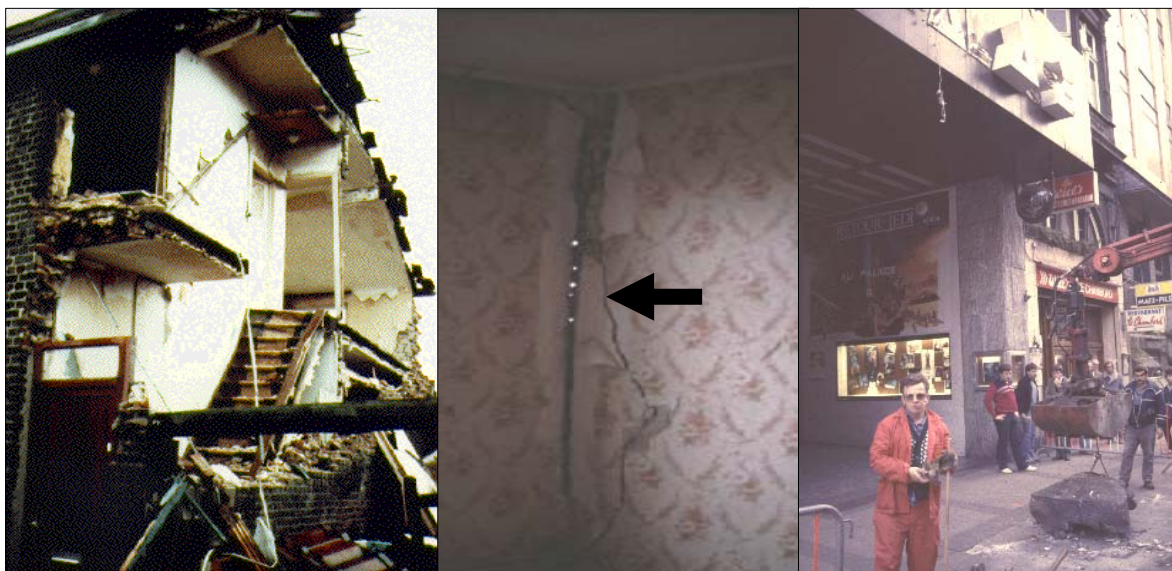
Liège, 1983. Effet de la faiblesse des diaphragmes (fissuration à l'angle des murs) ou de la faiblesse de leur connections aux murs (effondrement de façade). Chute d'un parement en pierre.
